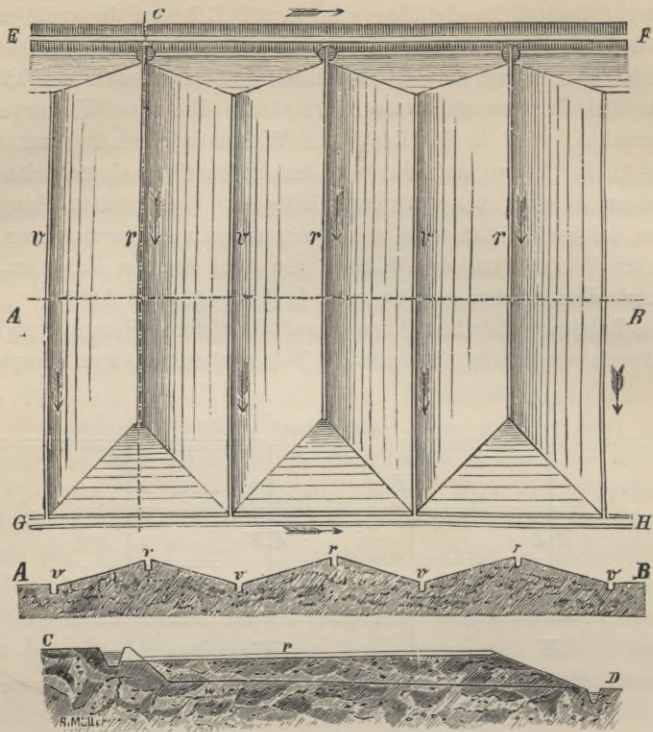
Rückenbau. Grundrifs, Querschnitt und Längsschnitt.
